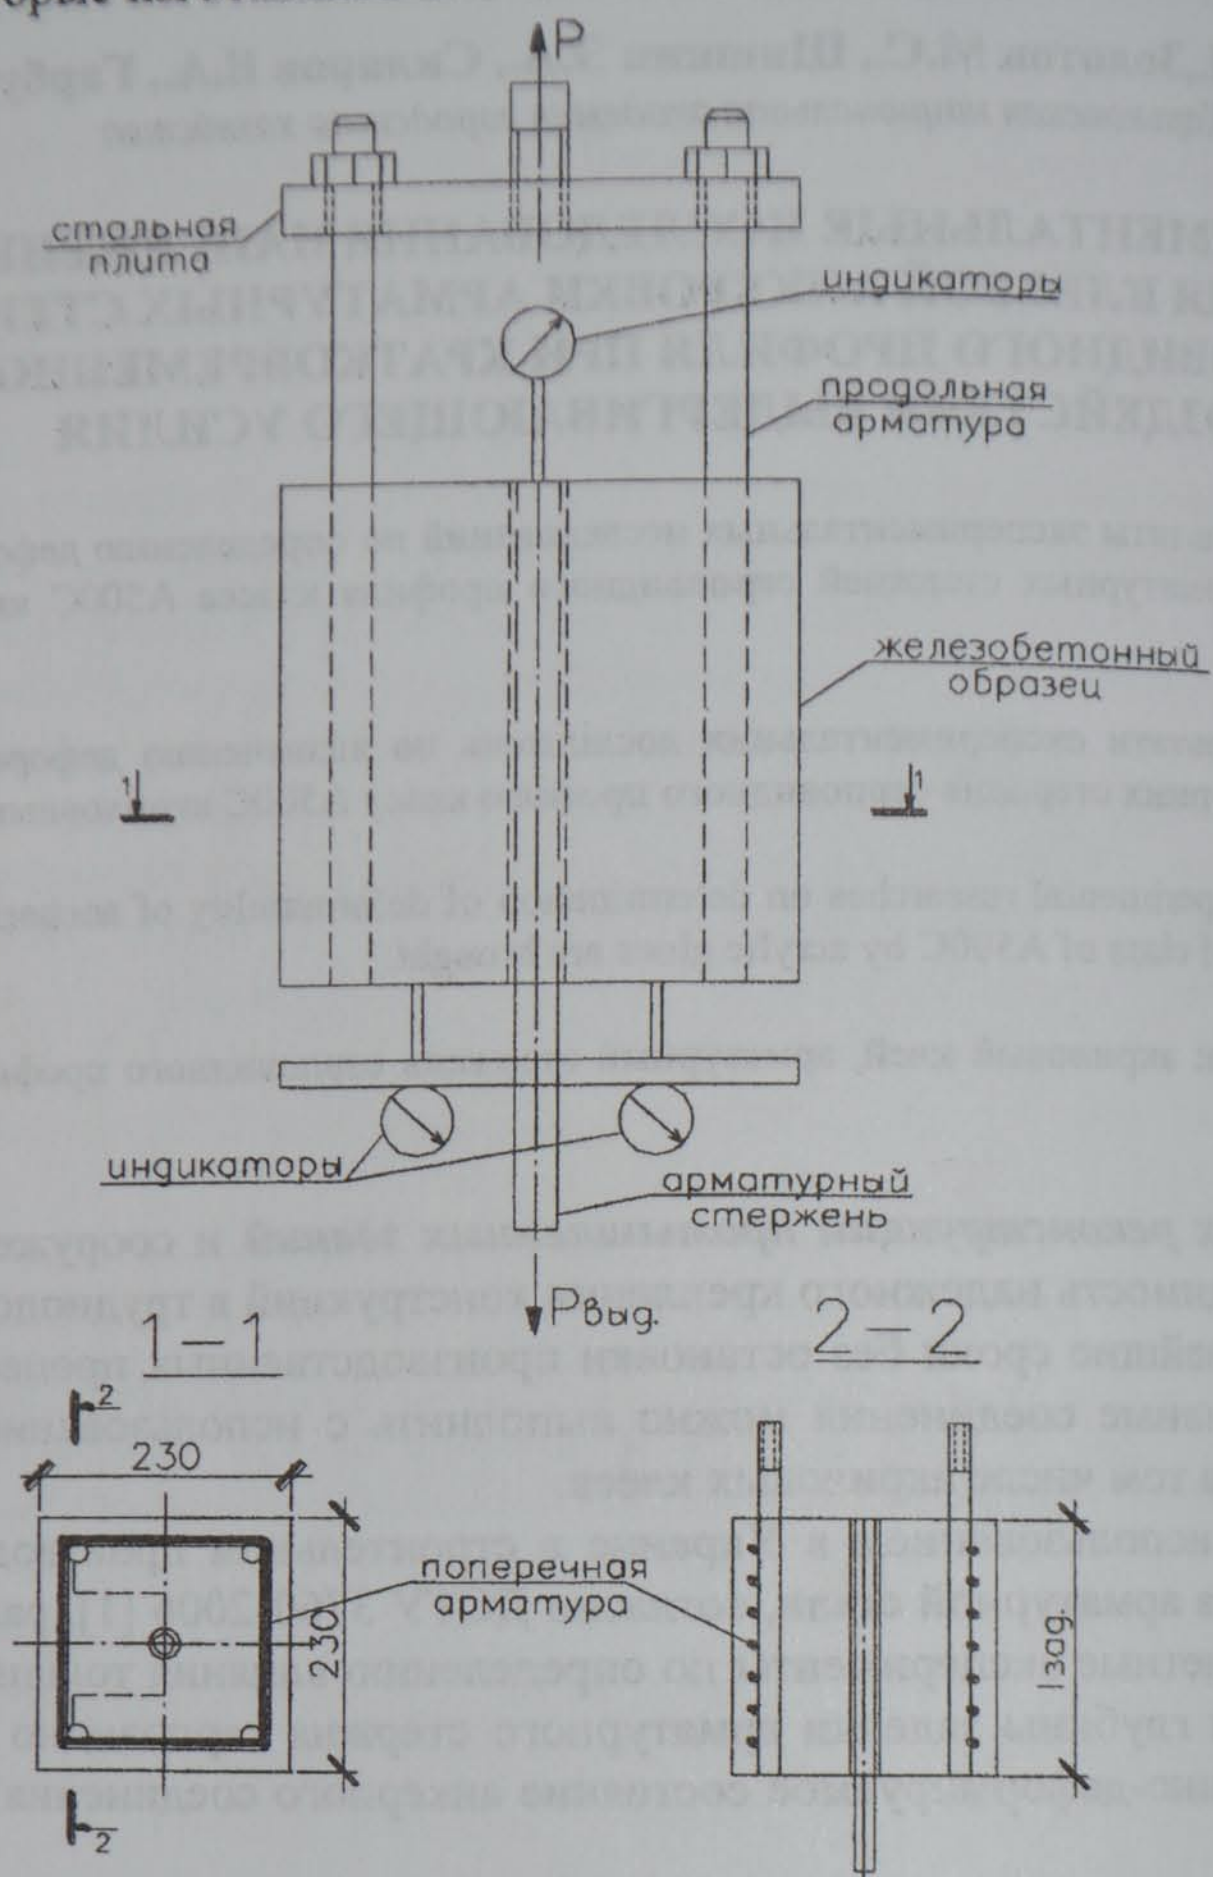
Образец анкерного соединения в результате заделки арматурного стержня в железобетонный образец и схема испытаний на выдергивание
